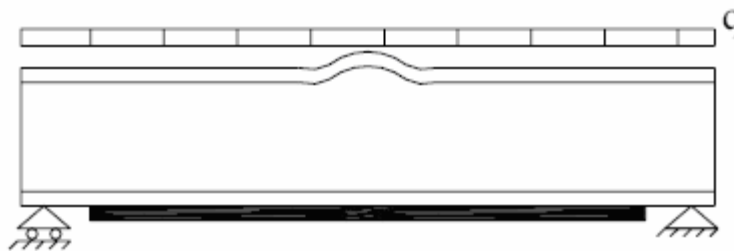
Instabilité locale par rupture en compression de la poutre en I
